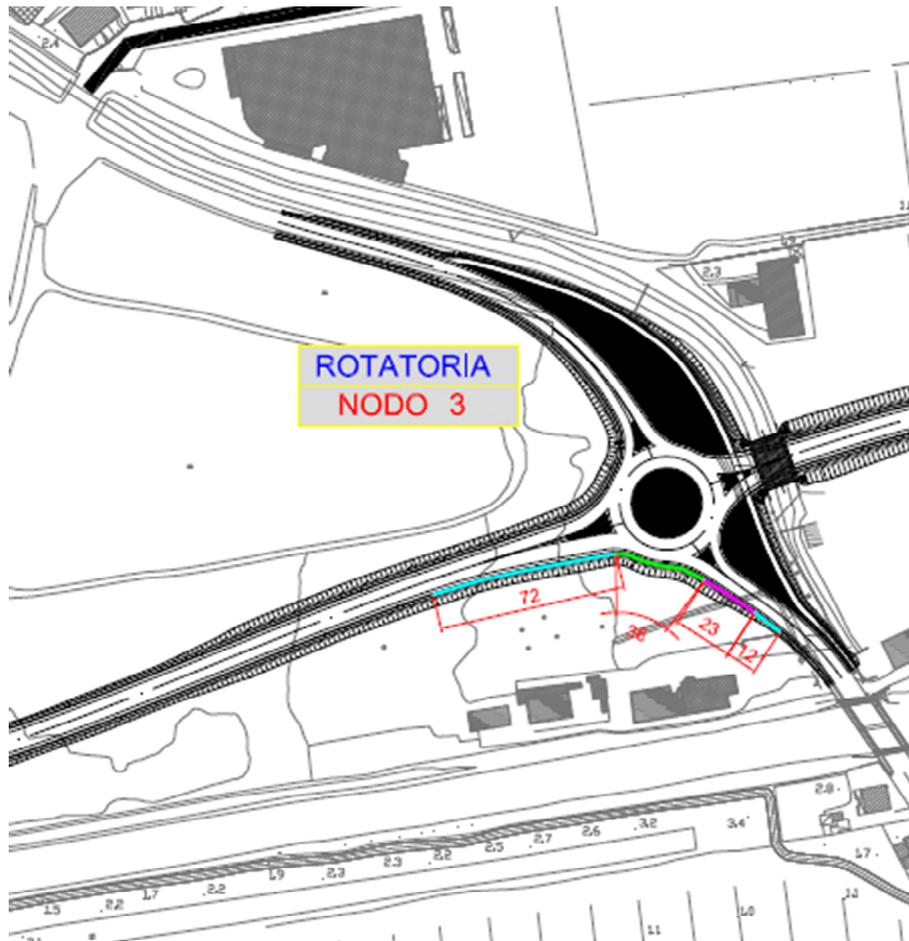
Planimetria barriere acustiche nodo 3 (lotto 1-3)
